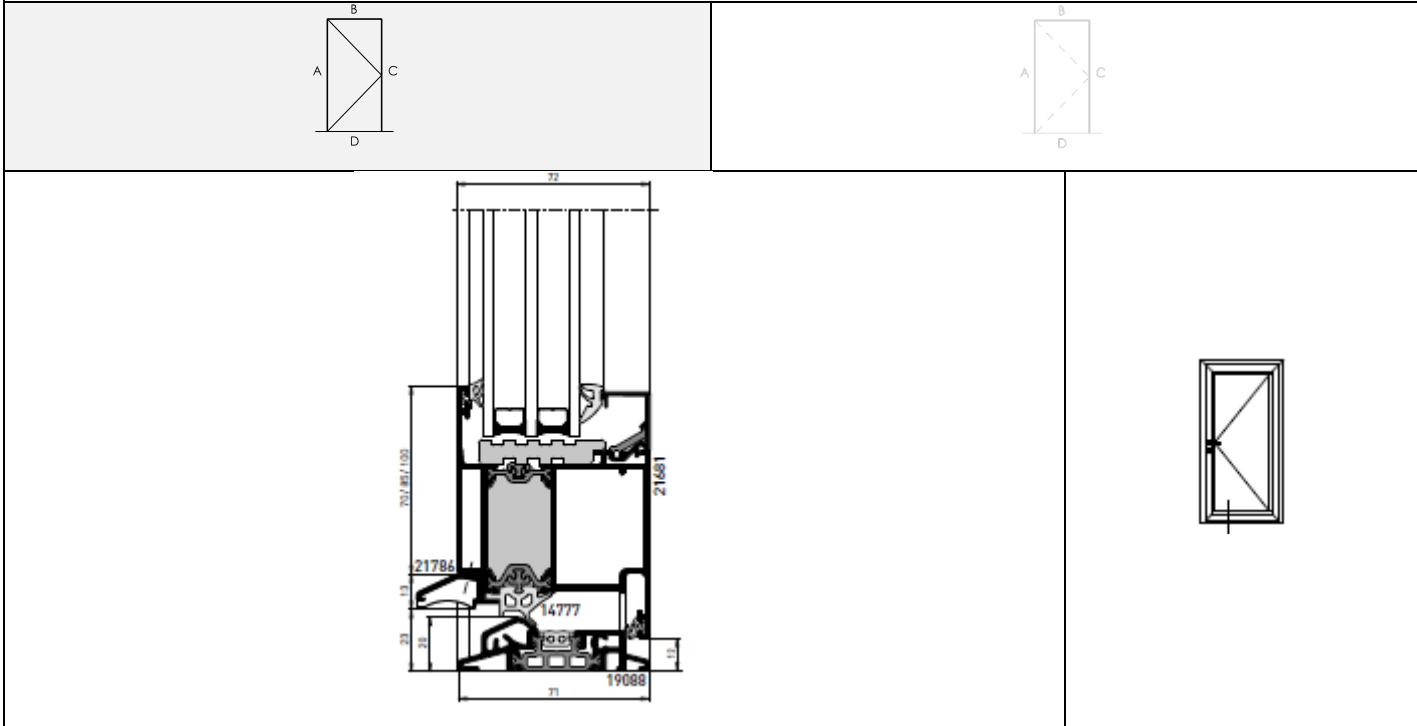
Coupe type porte avec panneau ouvrant vers l'intérieur
